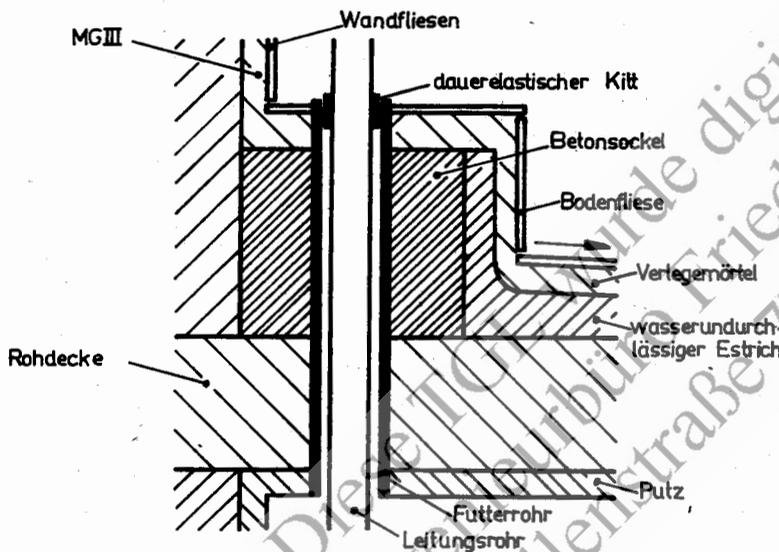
Vollständige Sickerwasserdichtung eines Raumes mit wasserundurchlässigem Putz und Estrich
